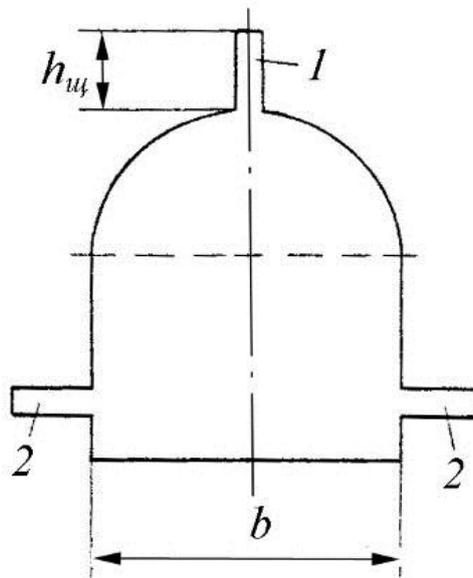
Охрана горизонтальной выработки компенсационными щелями: 1 – щель в кровле выработки, 2 – щель в боках выработки, b – ширина выработки, $h_{щ}$ – глубина щели
